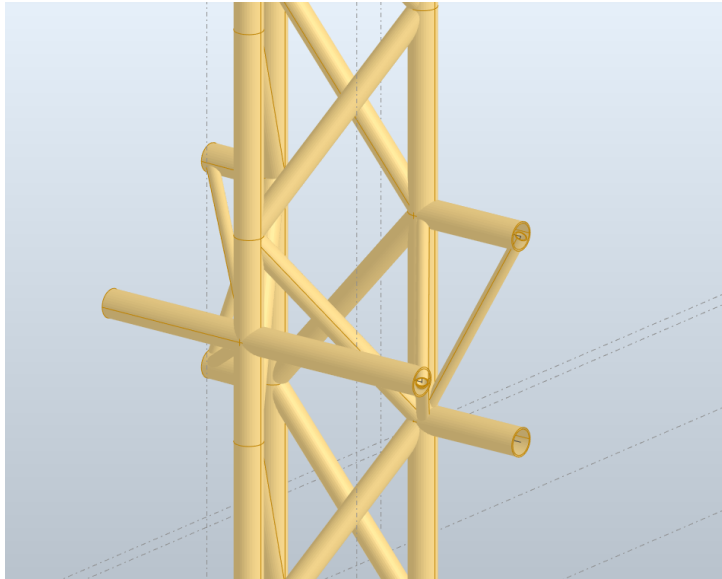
Vue tridimensionnelle de l’assemblage entre la lisse de façade et le potelet
